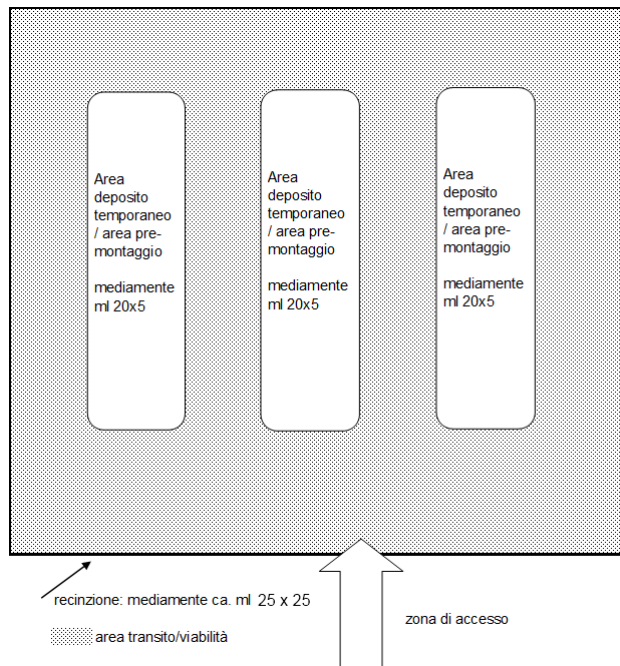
Planimetria dell'Area Sostegno (scavo di fondazione - getto e basi) - Tipologico
